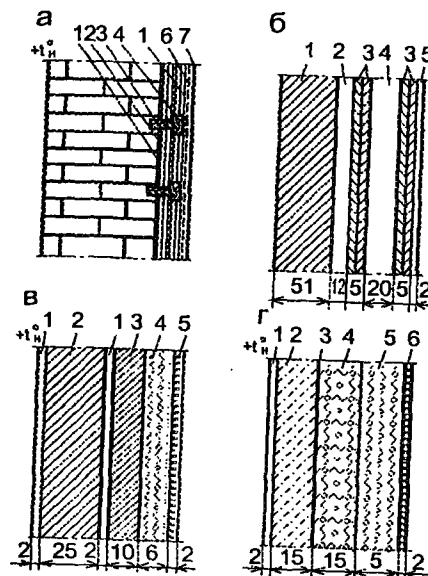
Схемы конструкций стен и горючей термоизоляции холодильников:
